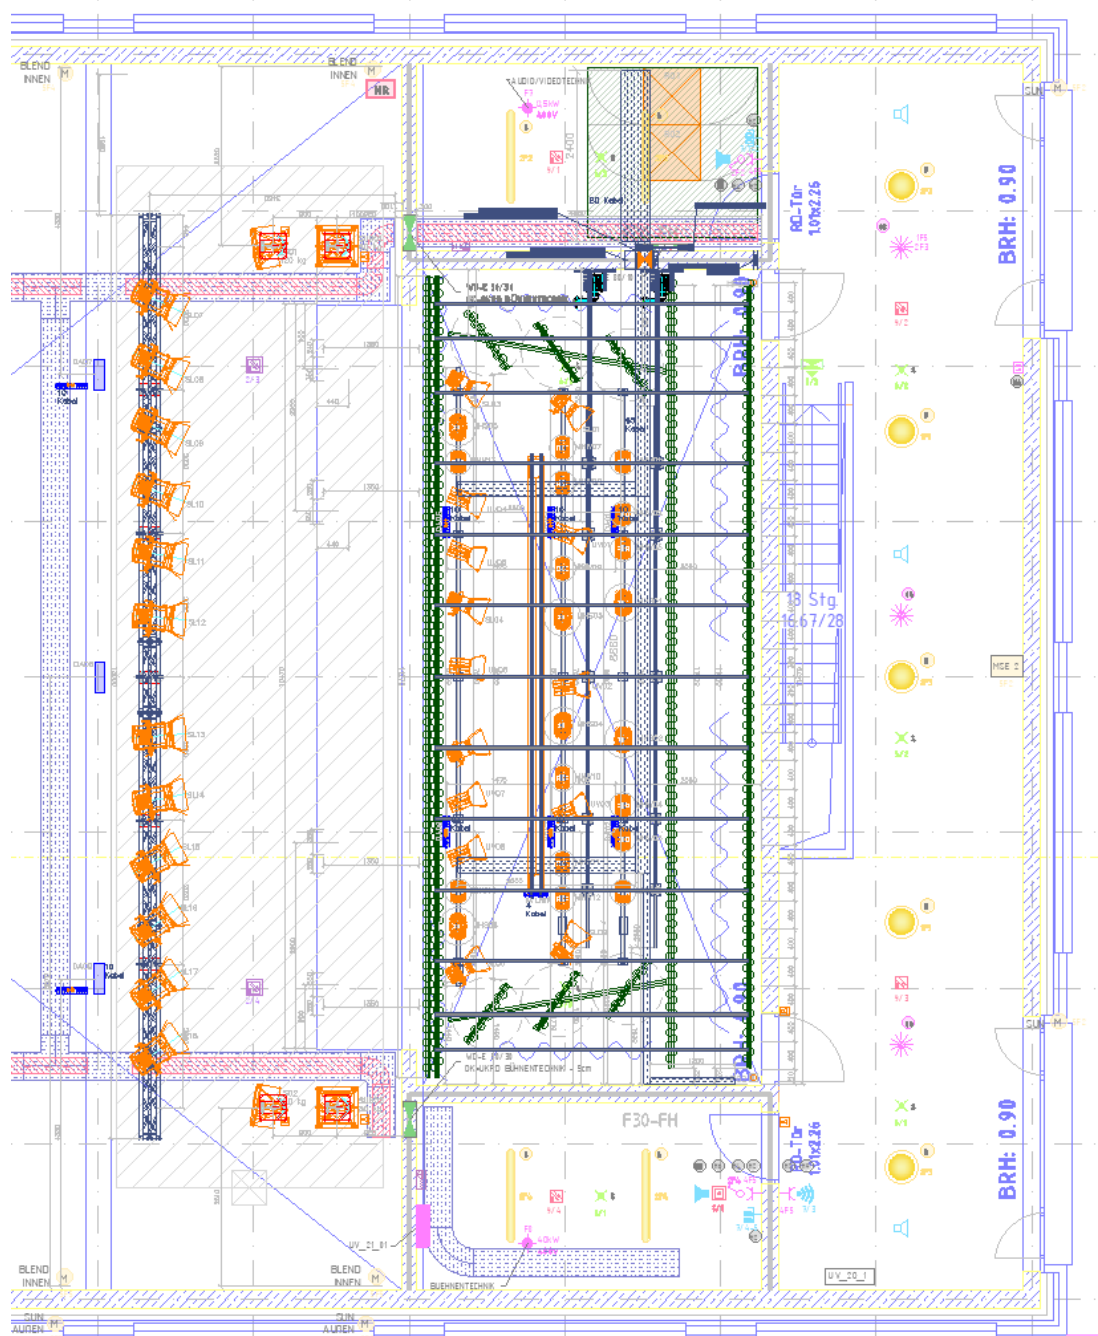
Grundriss 1.OG, Technikraum und Obermaschinerie
